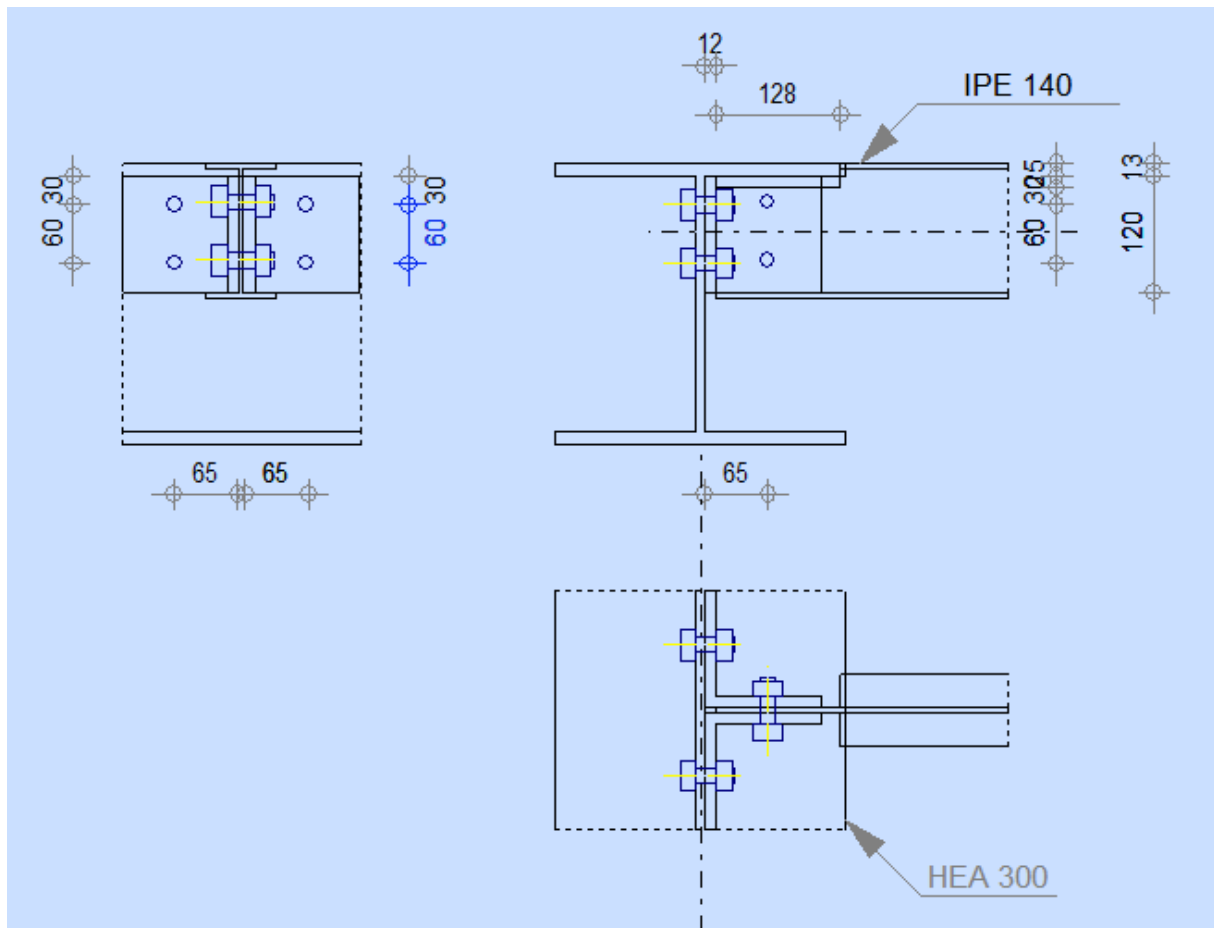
Disposition constructive d'assemblage poutre-solive
